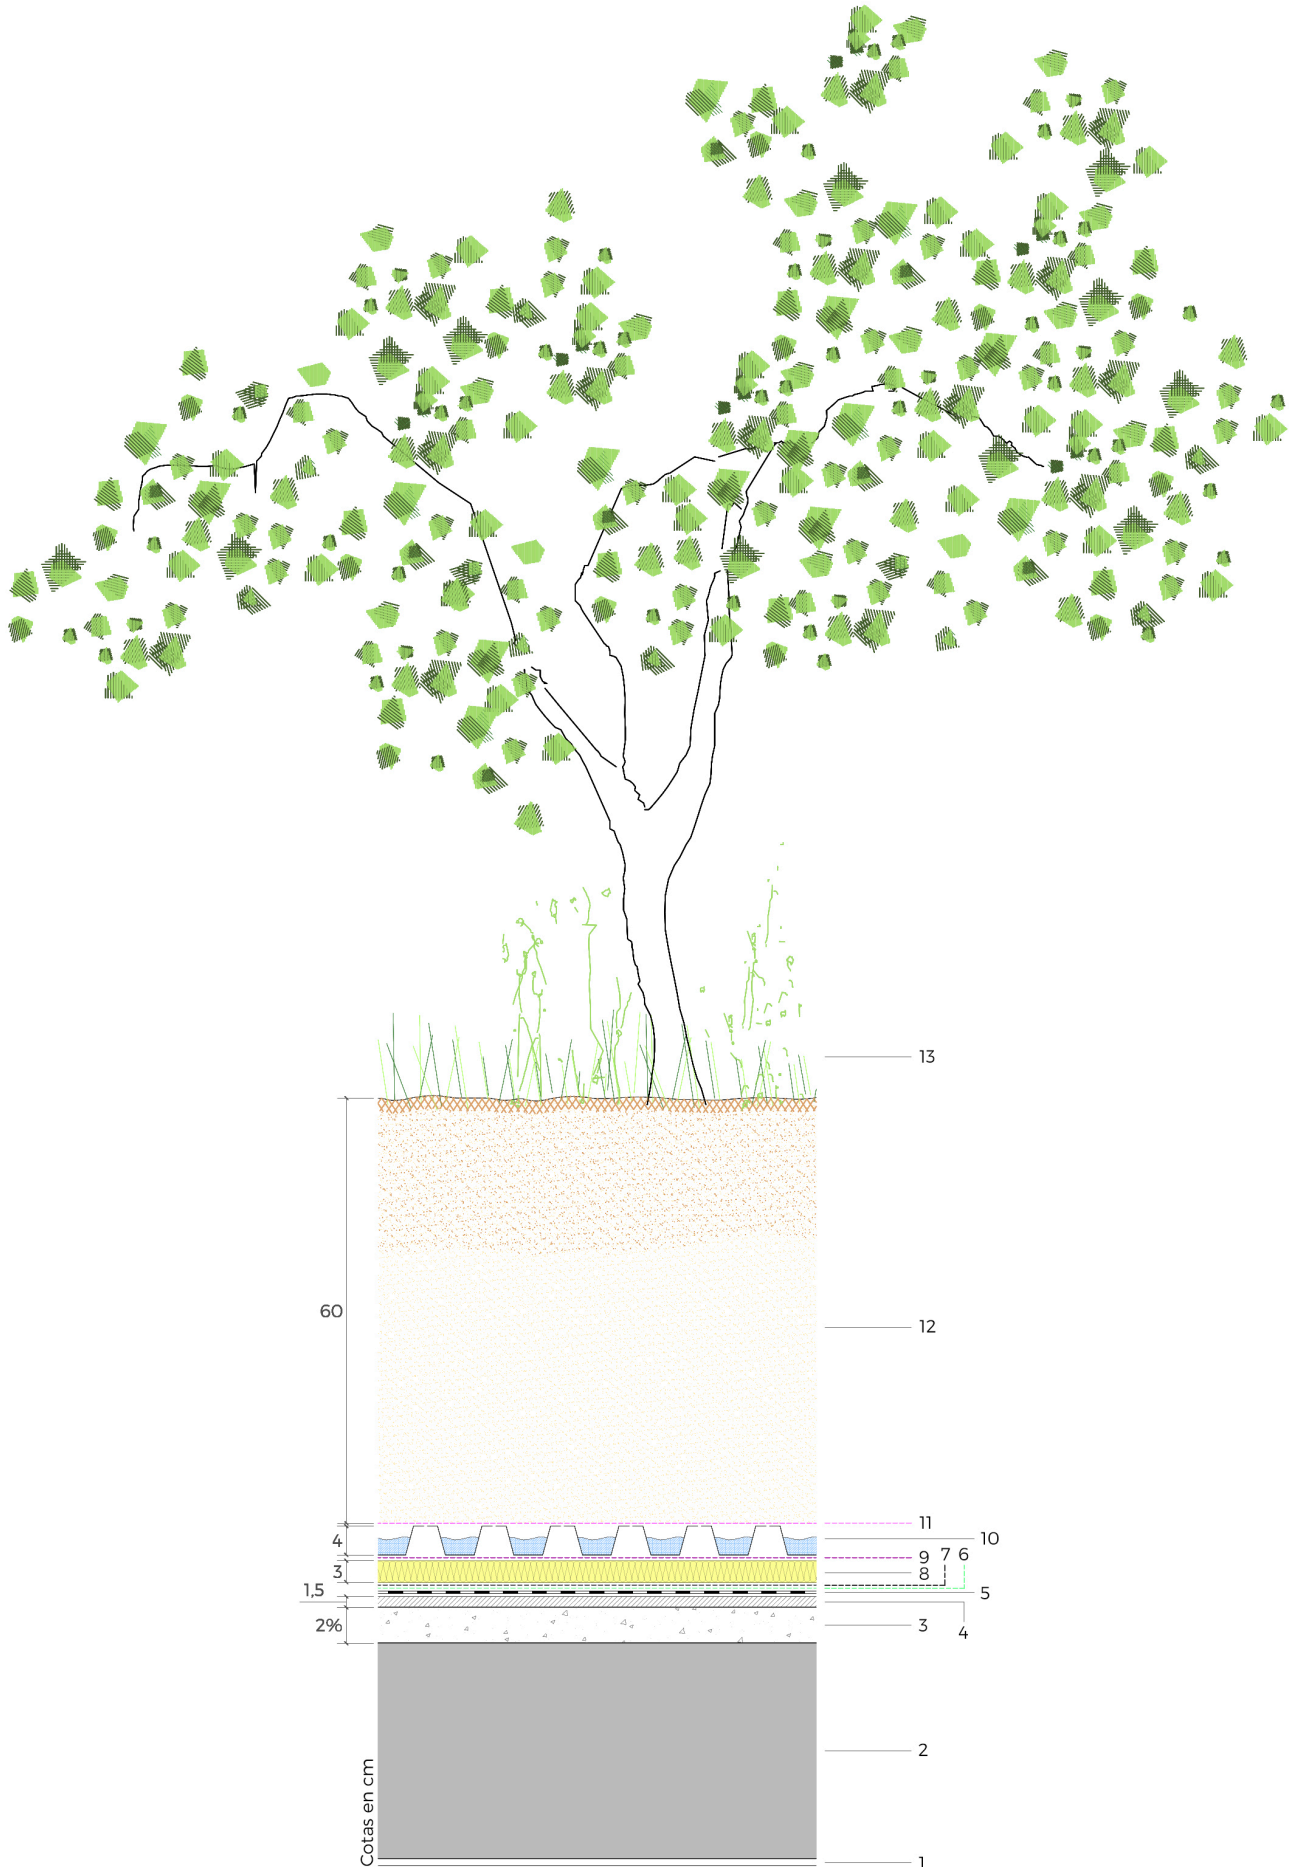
Detalle constructivo del modelo 4 - modelo C.
